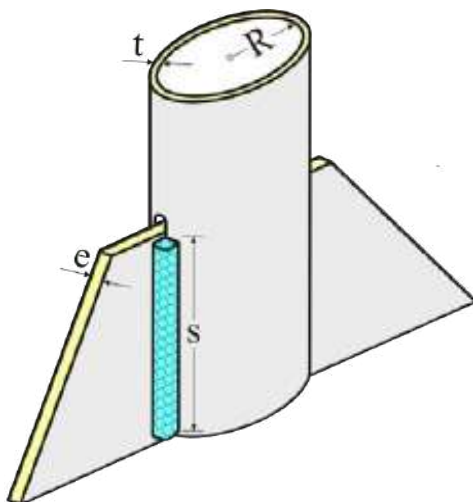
Empalme soldado en prolongación chapa-tubo para estructuras metálicas.
